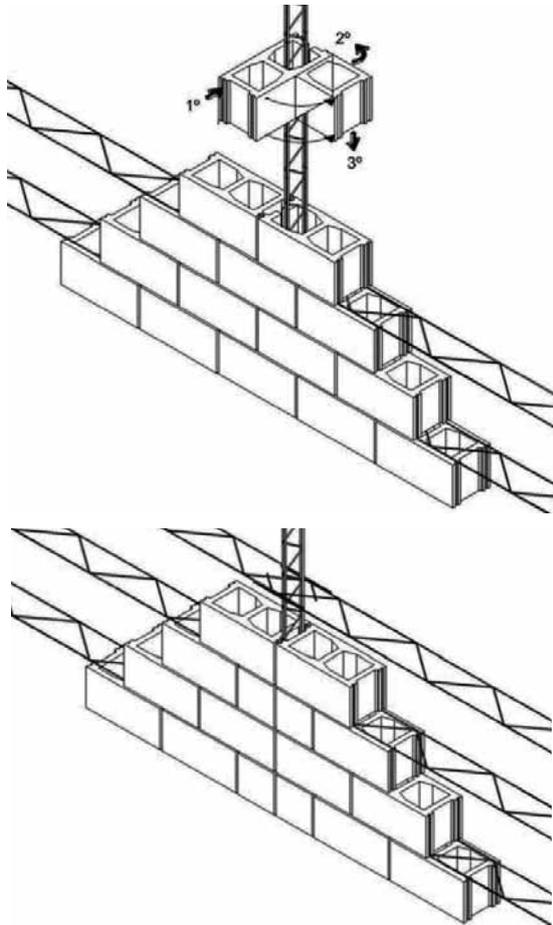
Posibles ubicaciones de las costillas en un muro de fábrica:
